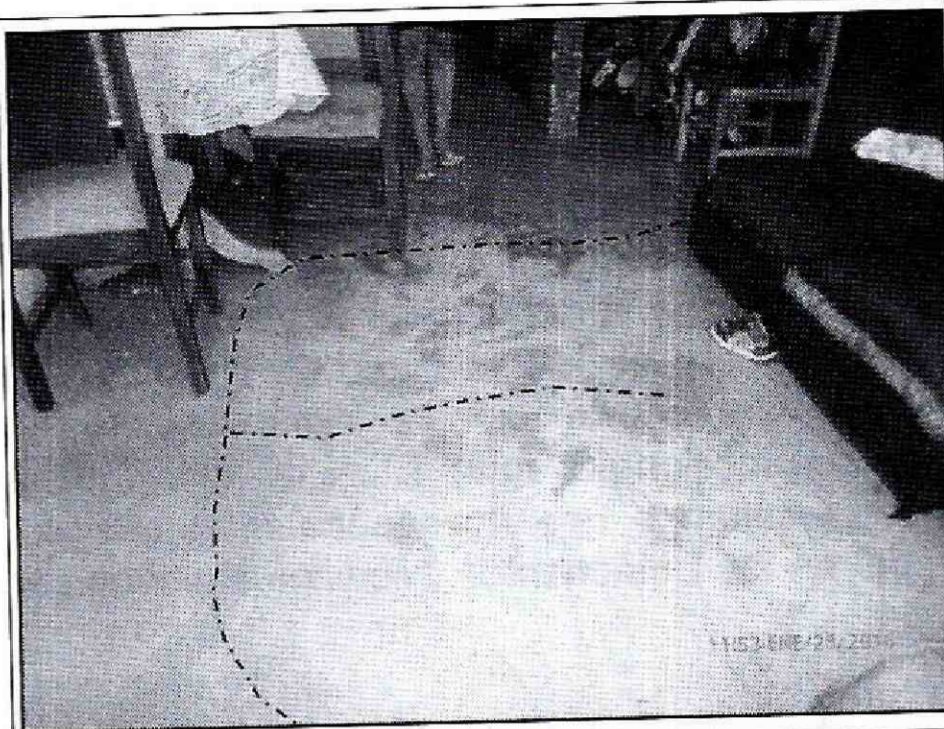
Vista de la placa de contrapiso de la vivienda evaluada, en la que se aprecian grietas longitudinales, las cuales no comprometen la estabilidad estructural y habitabilidad de la misma.
